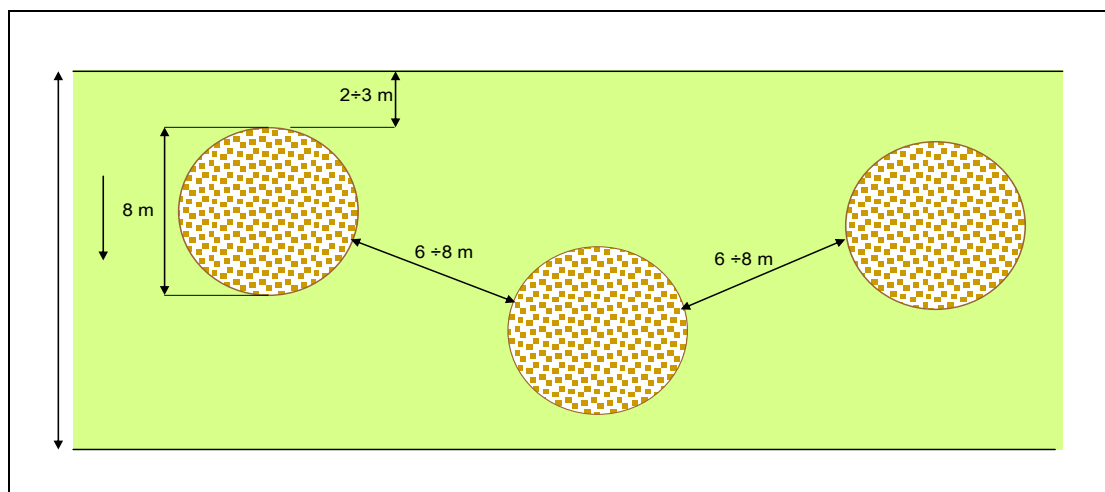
Schema della disposizione planimetrica delle isole vegetazionali all'interno dell'area di passaggio
